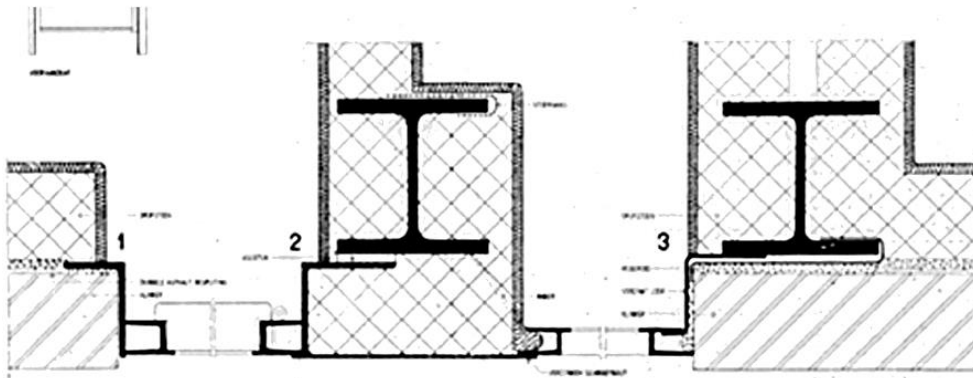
Detalle constructivo. Fuente: Bouwkundig\_weekblad\_Architectura 56E Jaargang 1935
